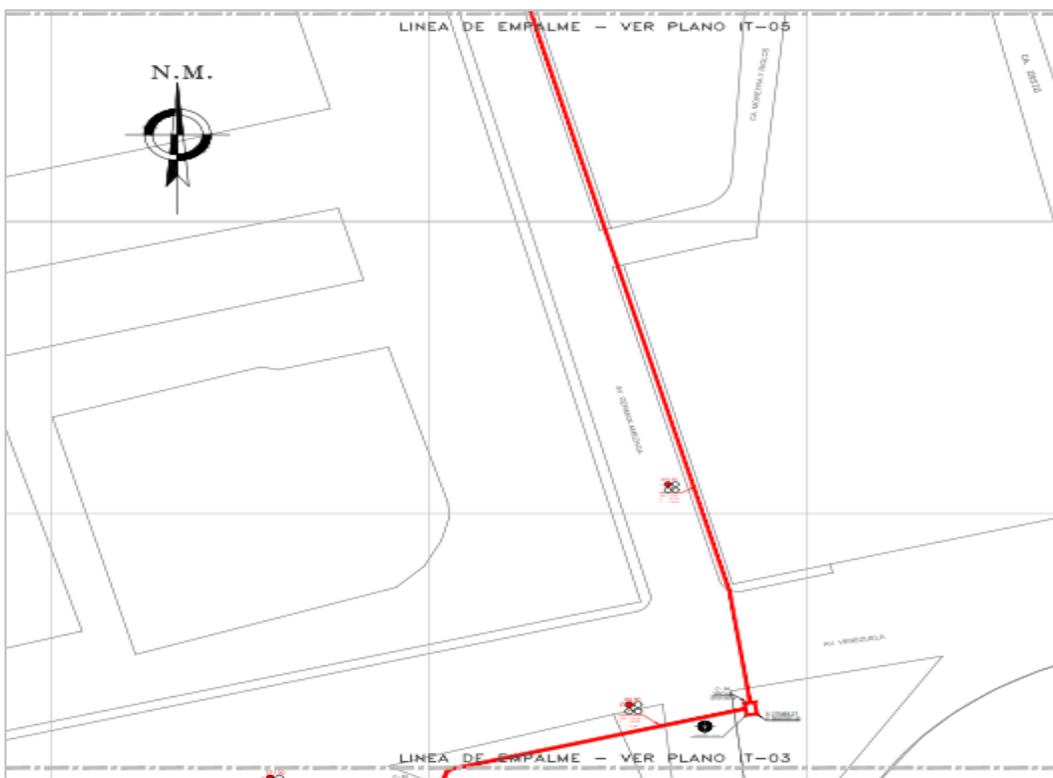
Plano de instalación de F.O. - canalizado.
